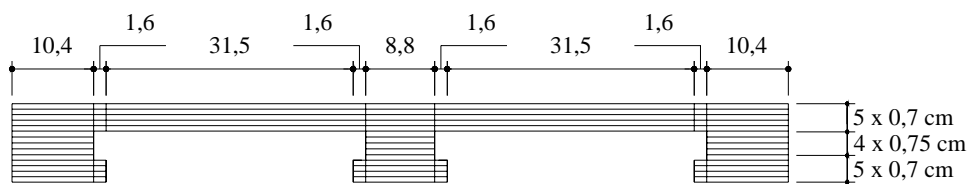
Discretização da seção transversal (dimensões em cm)
